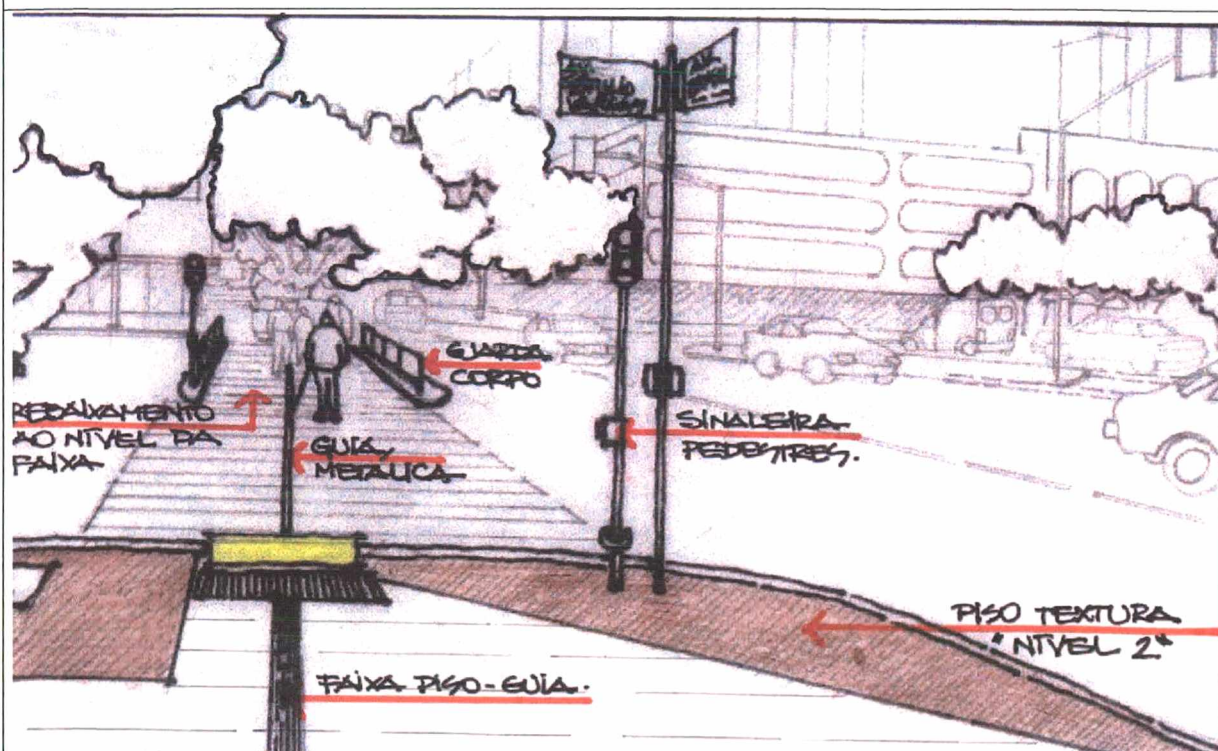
Vista do cruzamento : Avenida Getúlio Vargas x Avenida Brasil.
